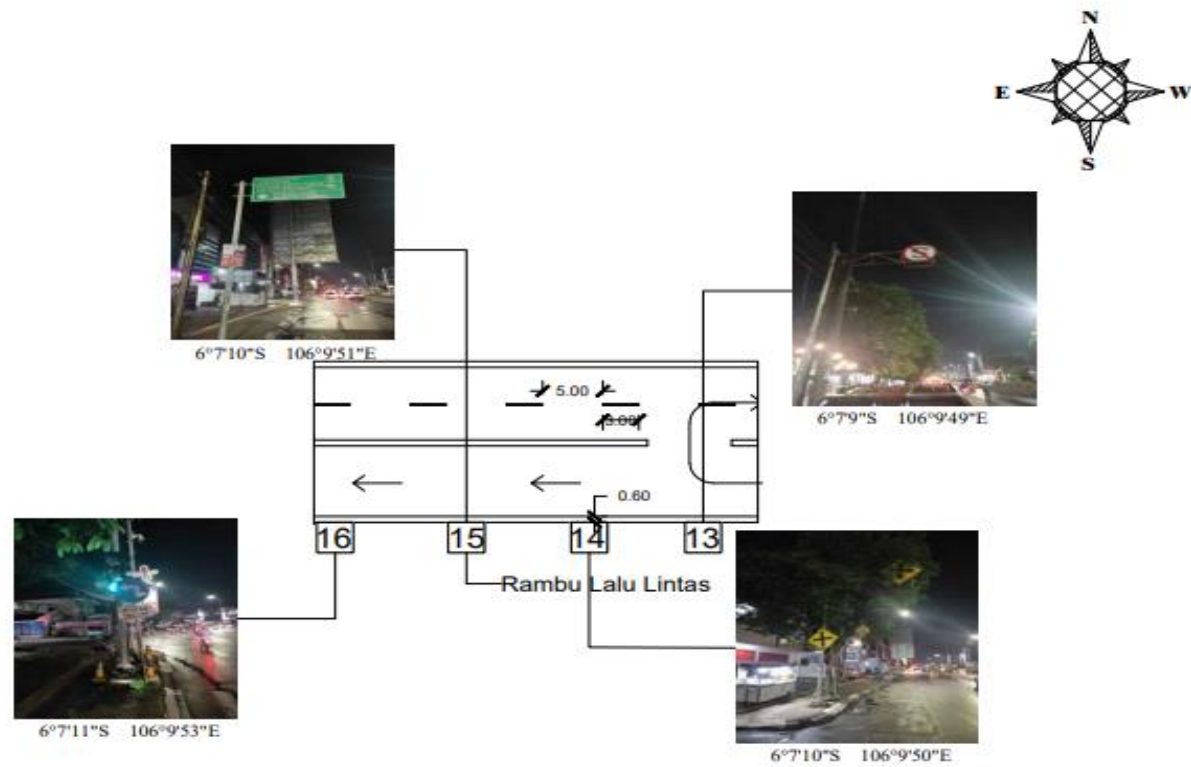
Potongan Site Plan Titik Lokasi Rambu
